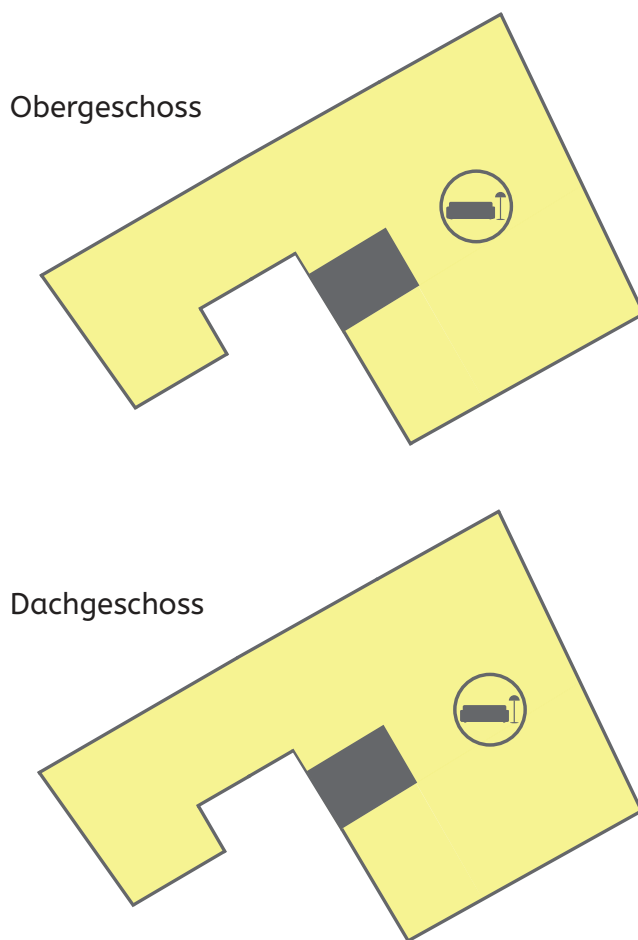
Grundrisse OG und DG Variante Neubau
